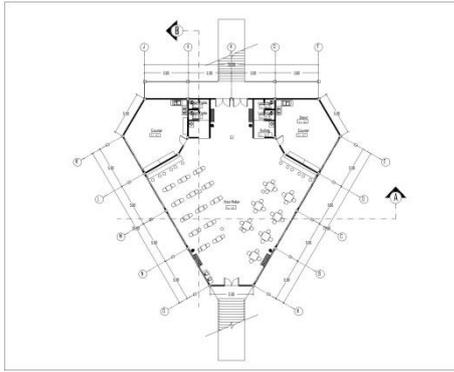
Denah Lantai 1 Ged. A (Mesjid)
